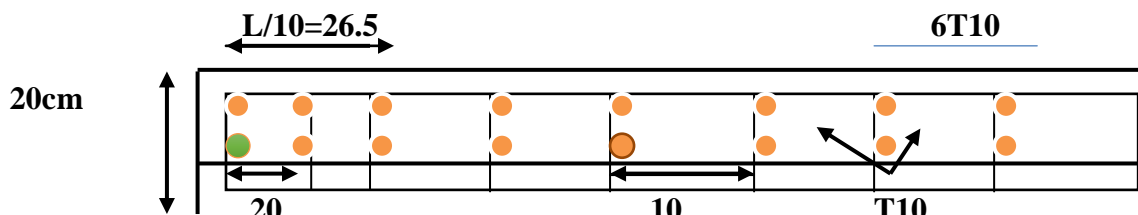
Schéma de ferrailage (1/2 voile)
